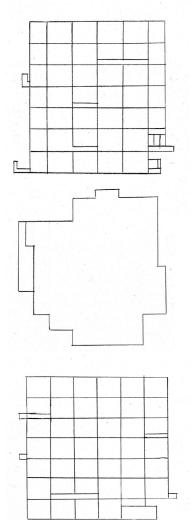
Sketsa kasar bangunan dalam game 3D Emendation
